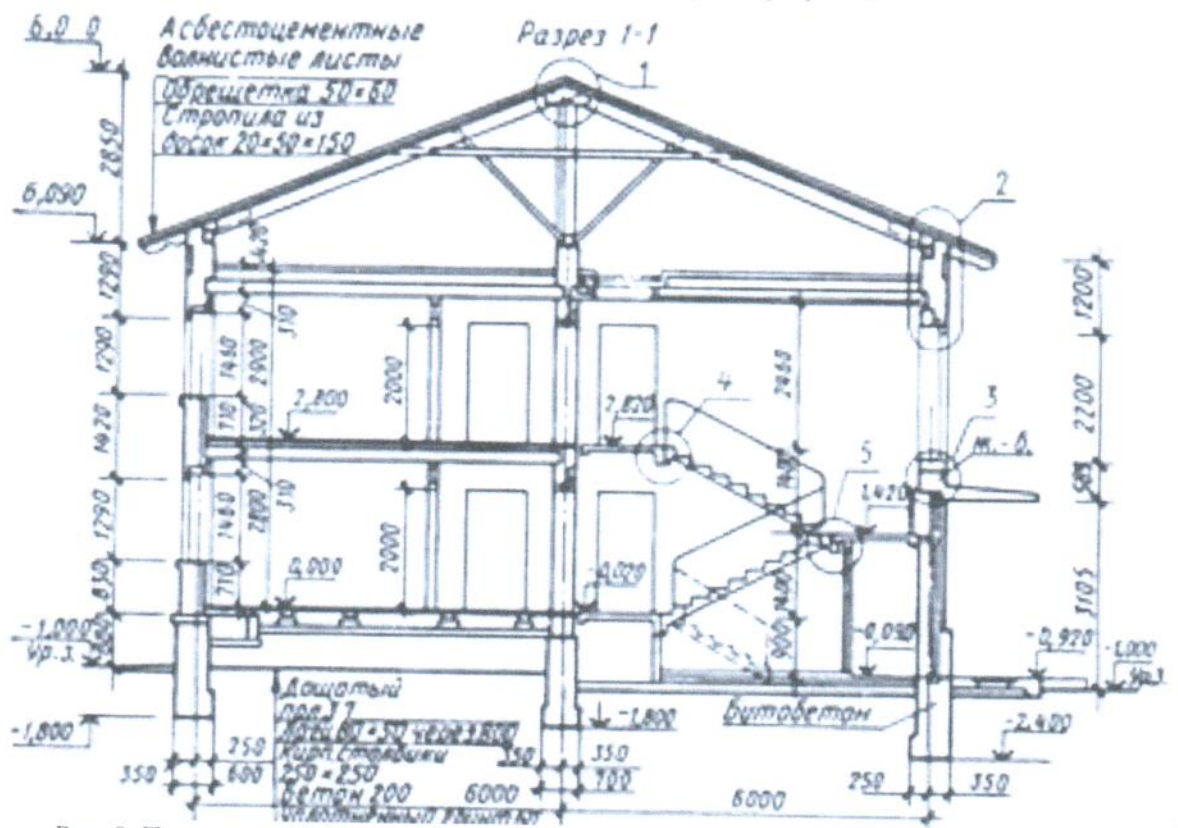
Примеры изображений разреза по лестнице малоэтажного жилого здания.
